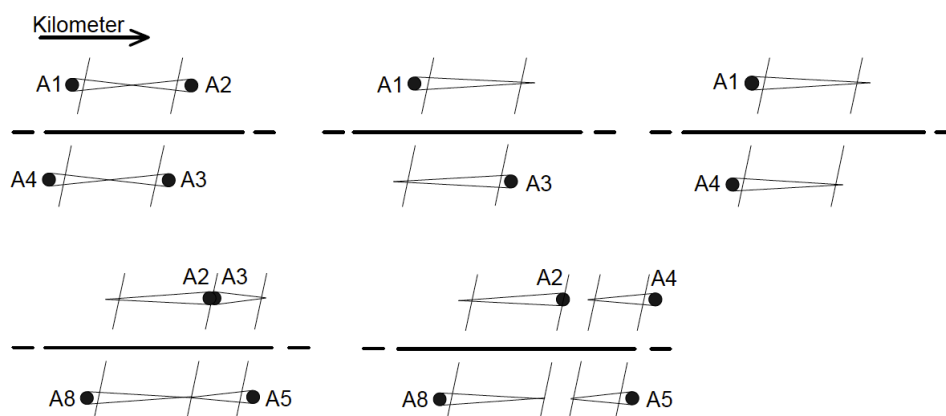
Bezeichnung der Schrankenanstriebe
